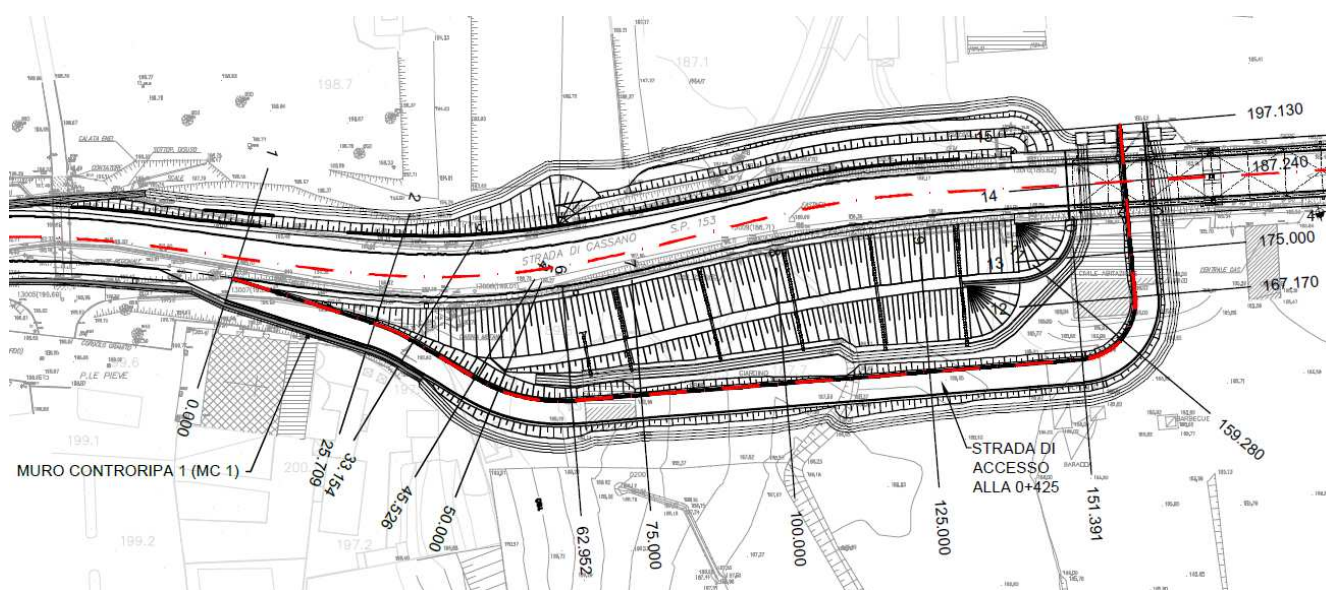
Stralcio planimetria dell'accesso alla 0+425
